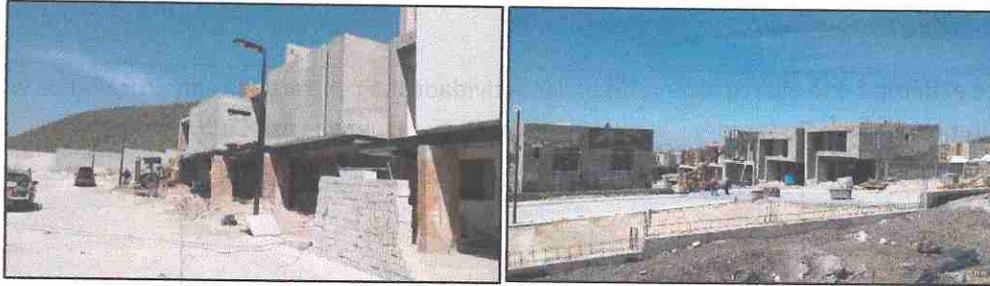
Trabajos de construcción de viviendas unifamiliares.
